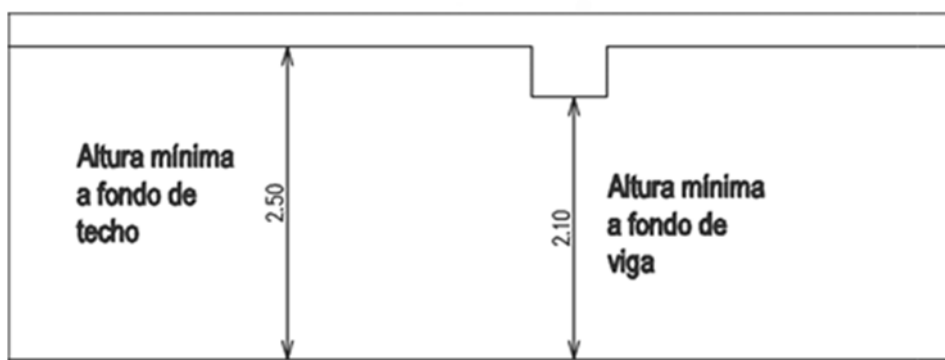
Altura mínima de piso a techo y piso a viga. (Fuente: Propia)
